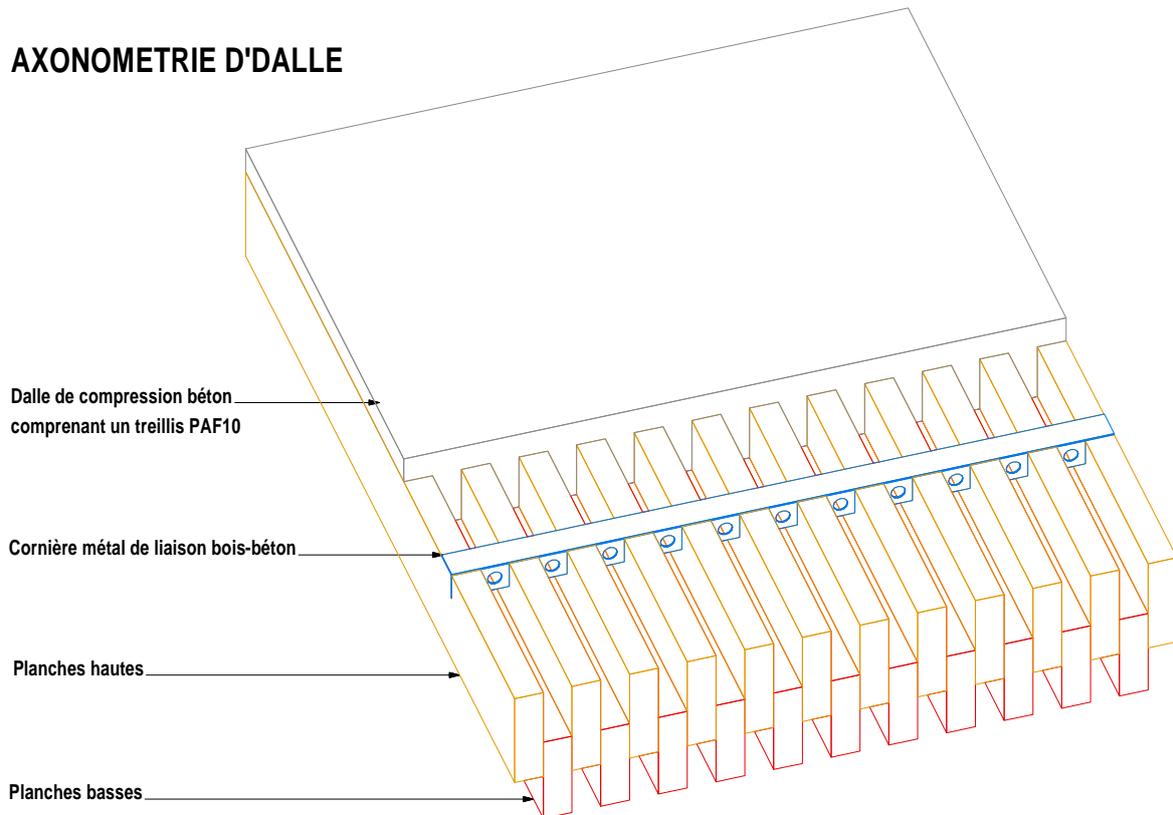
Coupe type du système D-Dalle intégrant le connecteur de liaison bois-béton
